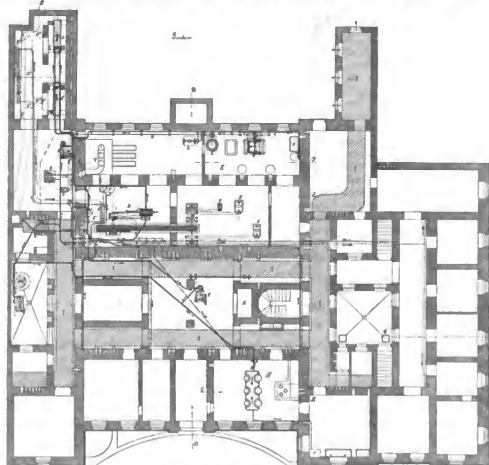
Grundriss des Souterrain 1:300.
